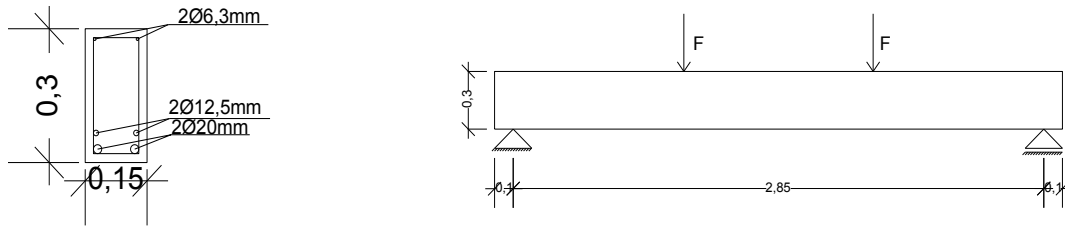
Seção transversal e carregamento da viga de concreto armado.
